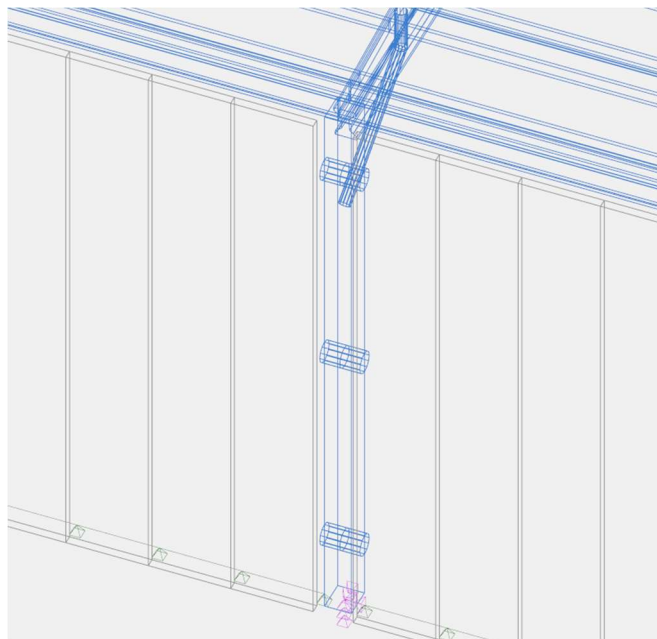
Elementi per valutare la tensione passante per i collegamenti tra pilastrini e pannelli murari
